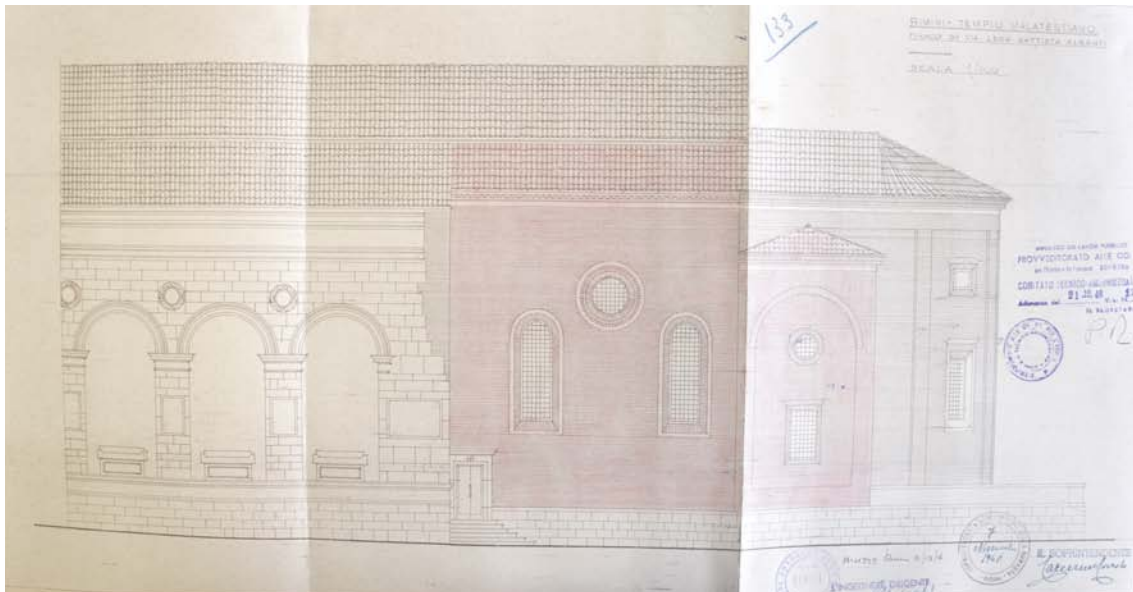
| Progetto di ricostruzione zona absidale. Prospetto su via Alberti
